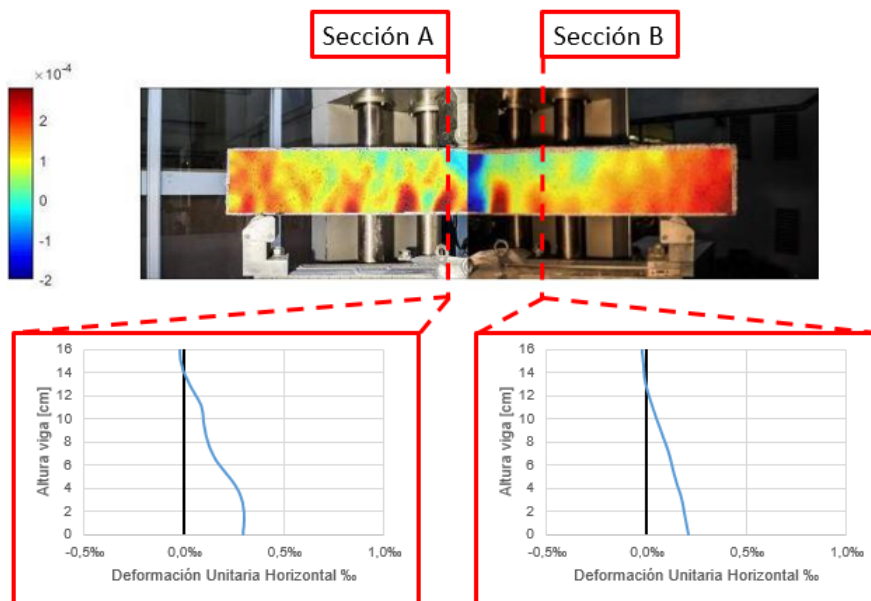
DUH en la fotografía 3. La sección A y B, se encuentran ubicadas a $0,3h$ y $1,5h$ desde el centro de la viga.
